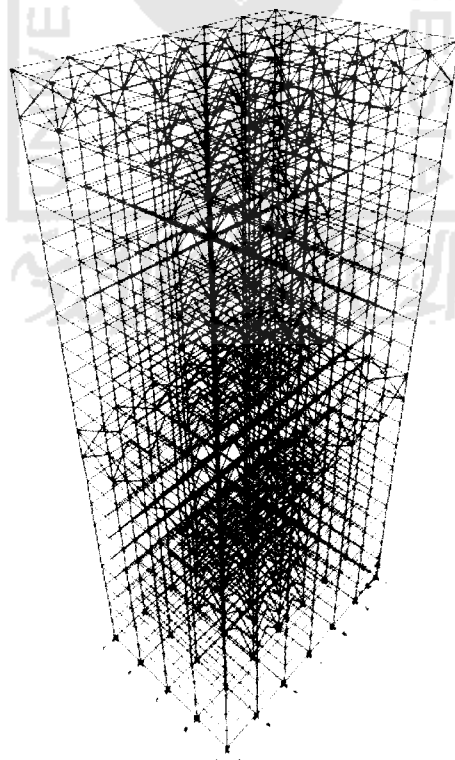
Denah struktur baja 20 lantai *Open Frame
